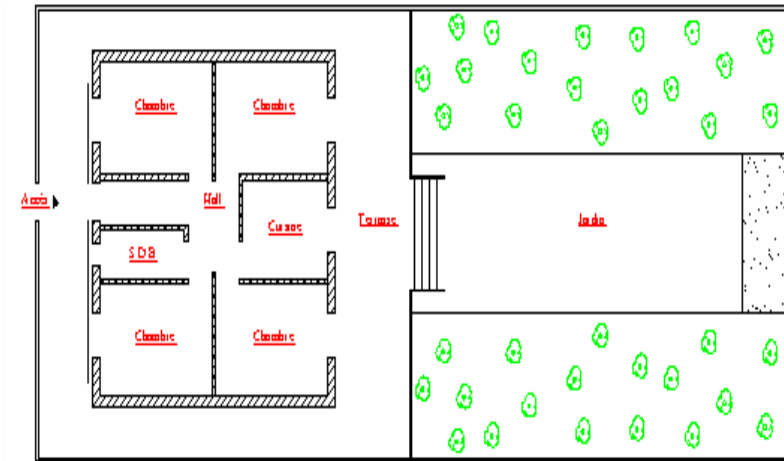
L'aspect original du lotissement pavillonnaire de « l'Ex Village Juif ».
